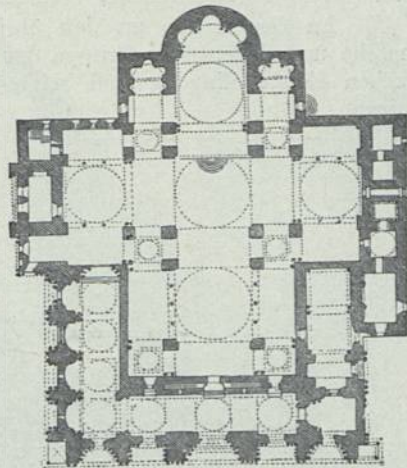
Grundriss von S. Marco zu Venedig
